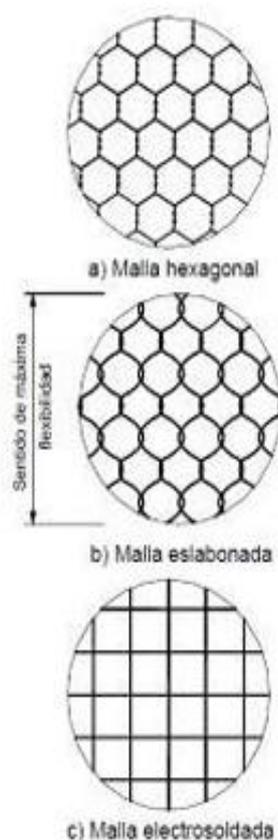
Tipos de mallas utilizadas en la construcción de gaviones. Fuente: (Suárez Díaz, 2001).
